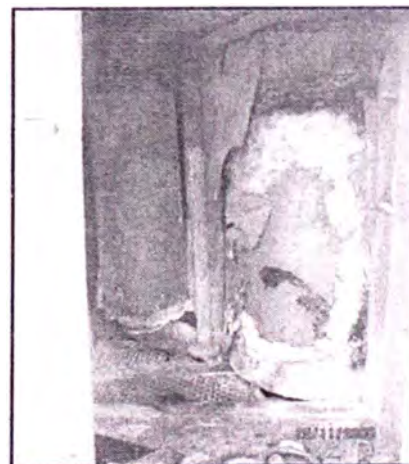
Rotura y retiro del concreto en la bodega central.
